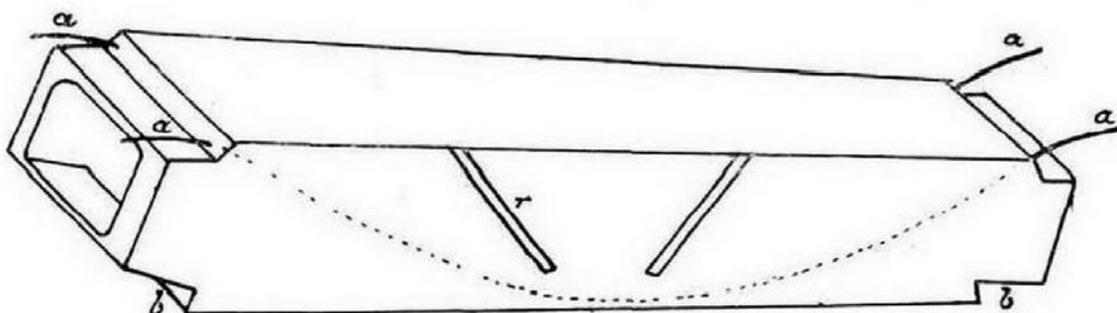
Elementos de concreto prefabricados que descansaban sobre las pestañas de vigas de hierro; contenían varillas de hierro que se pasaban por los agujeros de las vigas para amarrarse con las siguientes.
